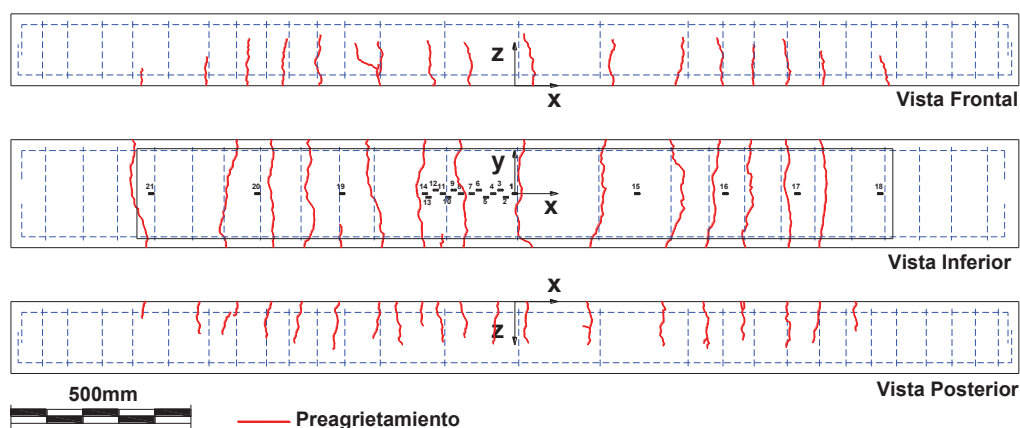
Esquema del patrón de preagrietamiento de viga 2B.
